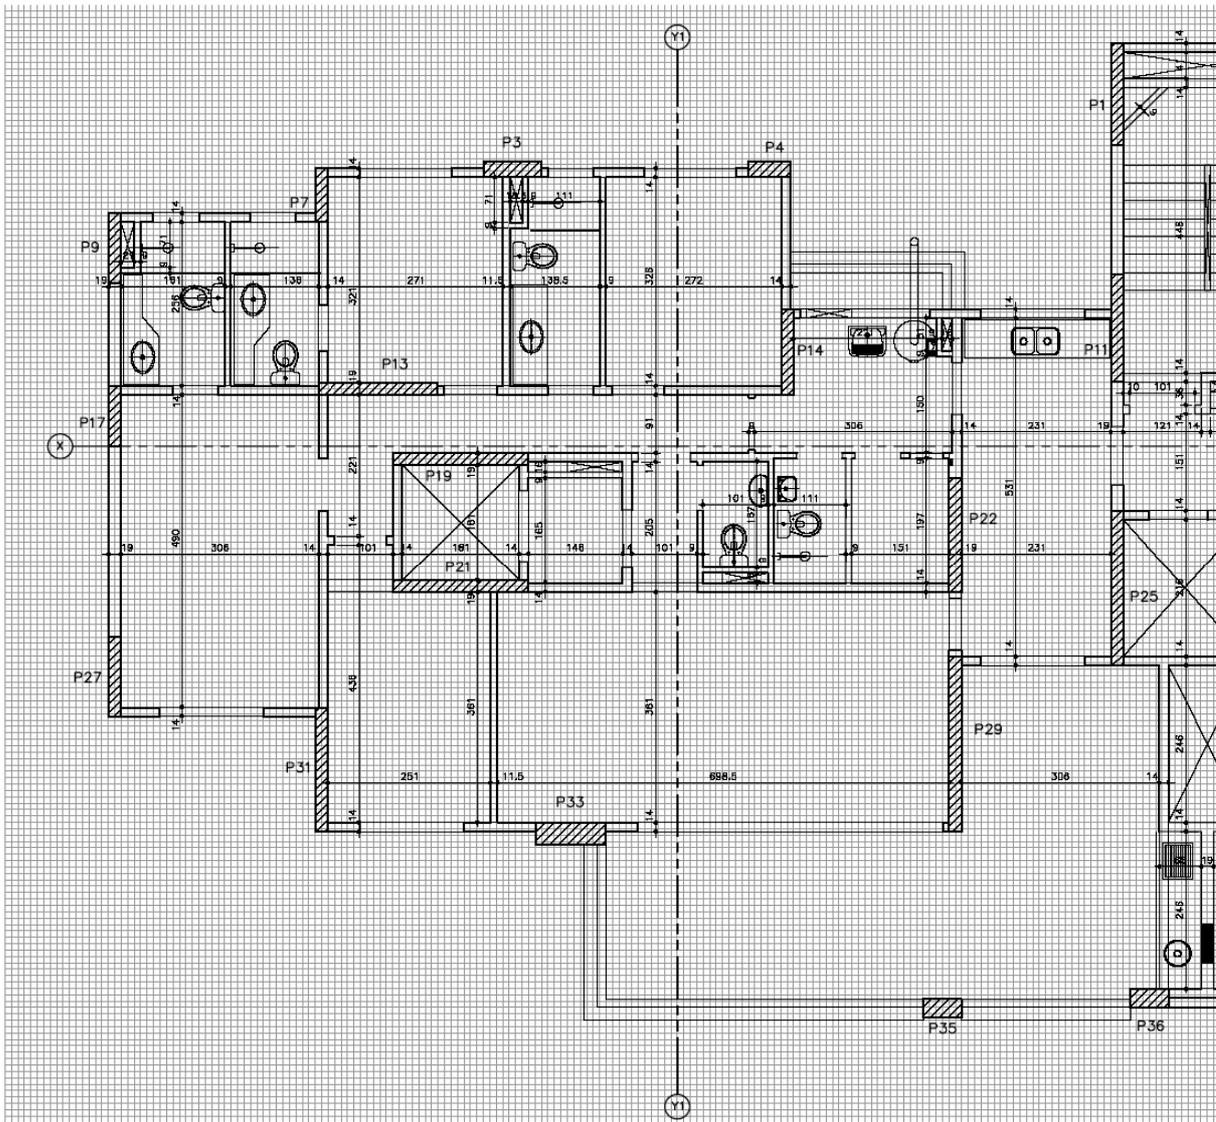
Planta coordenada modularmente do apartamento - Estudo de Caso B
